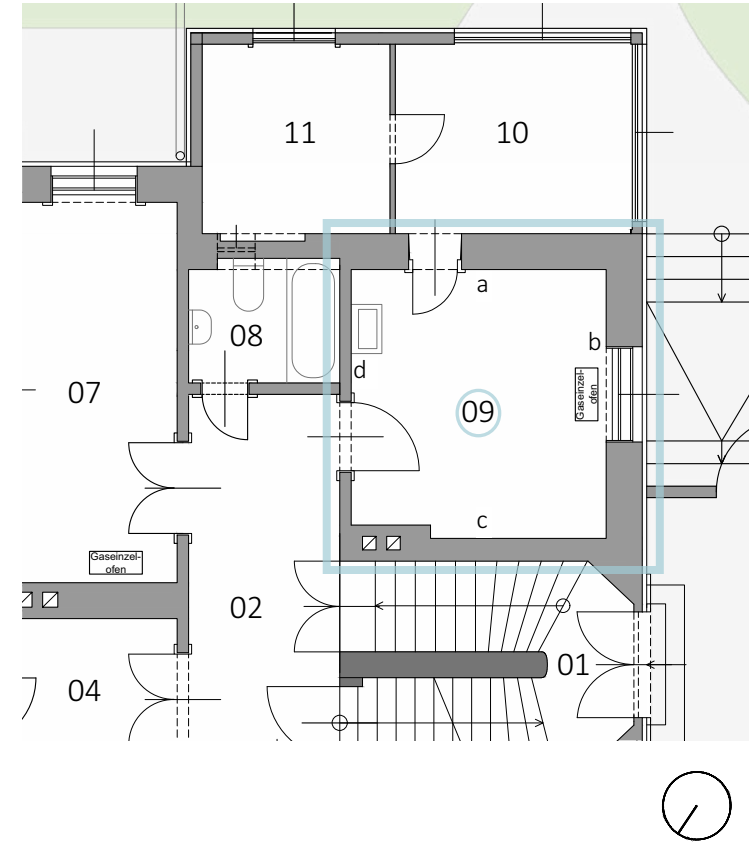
Grundriss OG 09 Küche, M=1:100.
